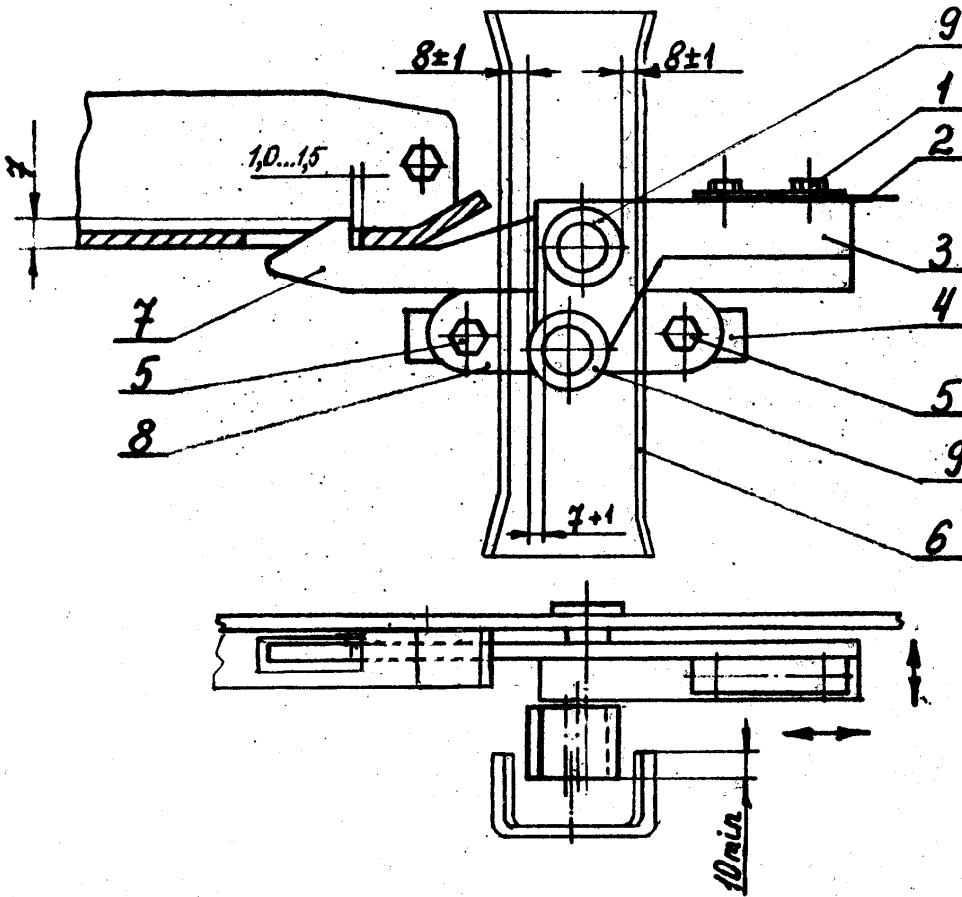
Зацепление пальца двулучевого рычага с защелкой замка пассажирского лифта г/п 320 кг : 1 – ролик защелки ; 2 - защелка; 3 - двулучеый рычаг створки двери шахты; 4 - ролик двулучевого рычага; 6 - контрогайки пальца; 7 – палец рычага
